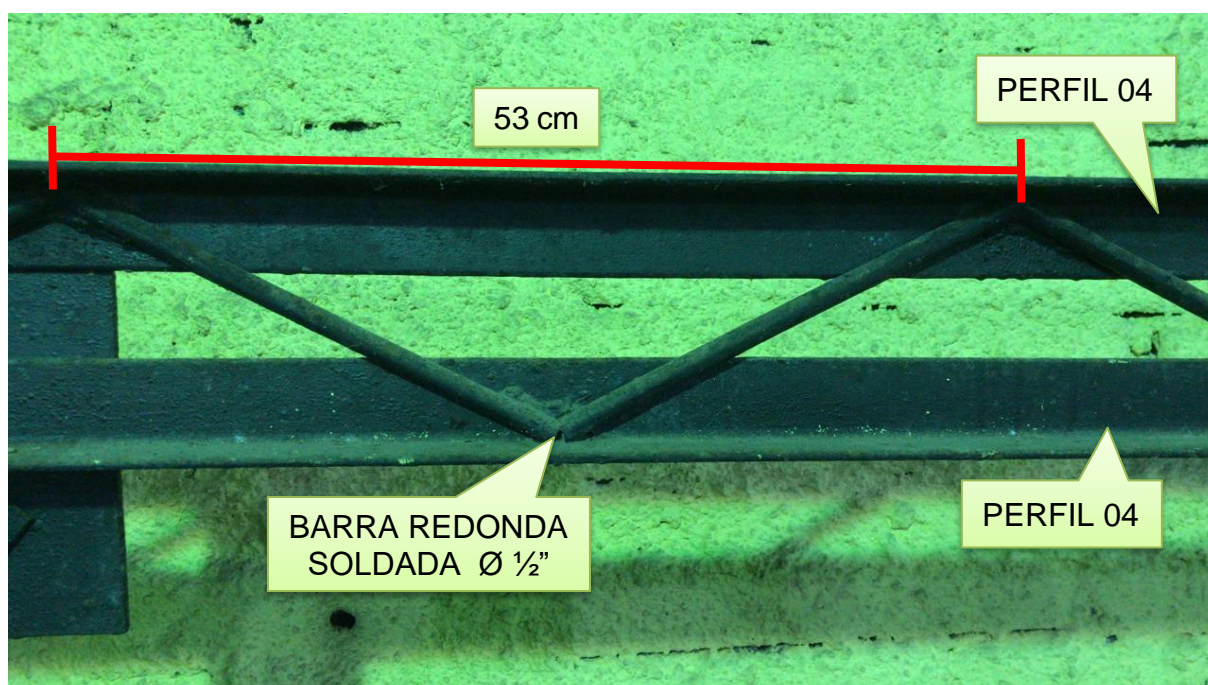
DETALHE DA BARRA DO TRAVAMENTO
